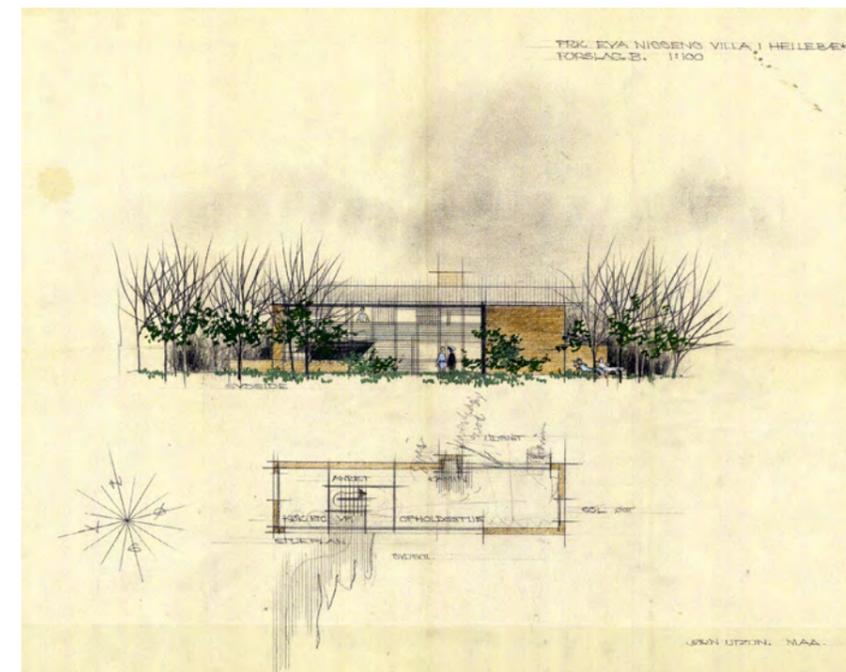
Alzado y planta de la *Nissens House*. Jørn Utzon, Hellebæk, 1952.
